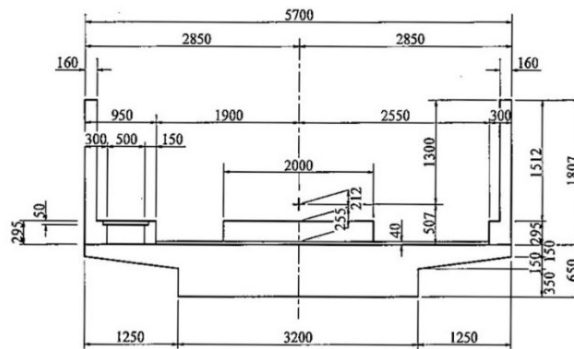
一般形状図—断面図 (断面 A-A) ^[7]
